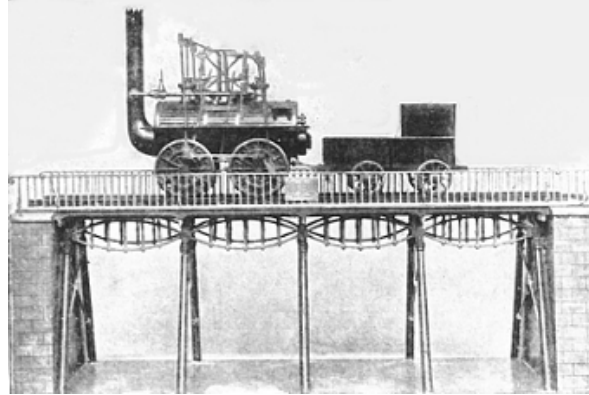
La "Locomotion", construida por Stephenson en 1825, sobre el primer puente ferroviario⁹²
